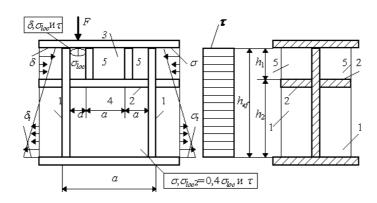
Схема балки, укрепленной поперечными основнымиребрами жесткости (1), продольным ребром жесткости (2), разделяющим отсекстенки на пластинку (3) у сжатого пояса и пластинку (4) у растянутого пояса, атакже короткими ребрами жесткости (5)
